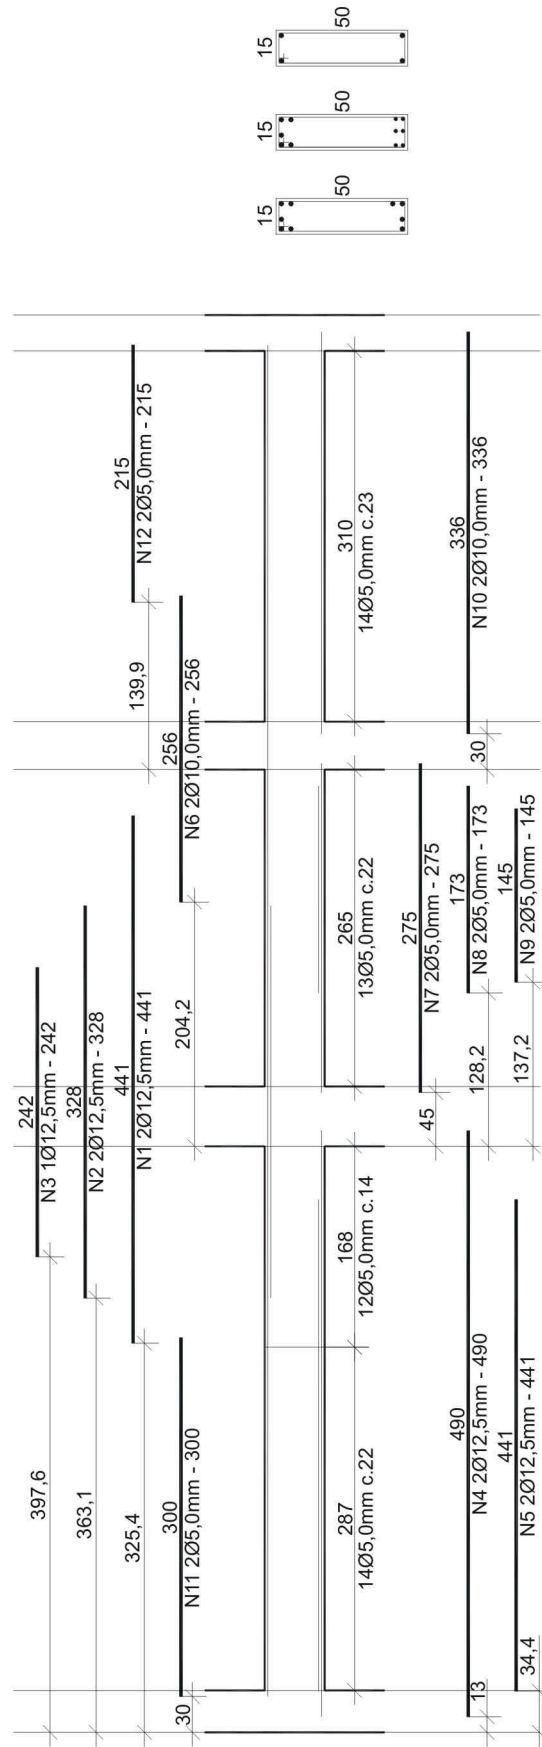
Detalhamento Viga 04.1, realizado pelo VigaCalc.
